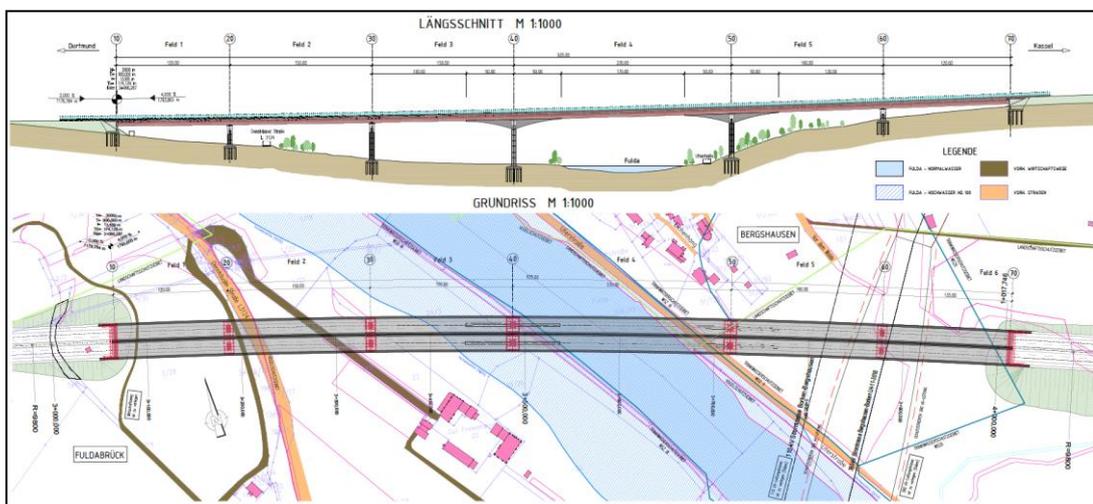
Längsschnitt und Grundriss Variante 2
